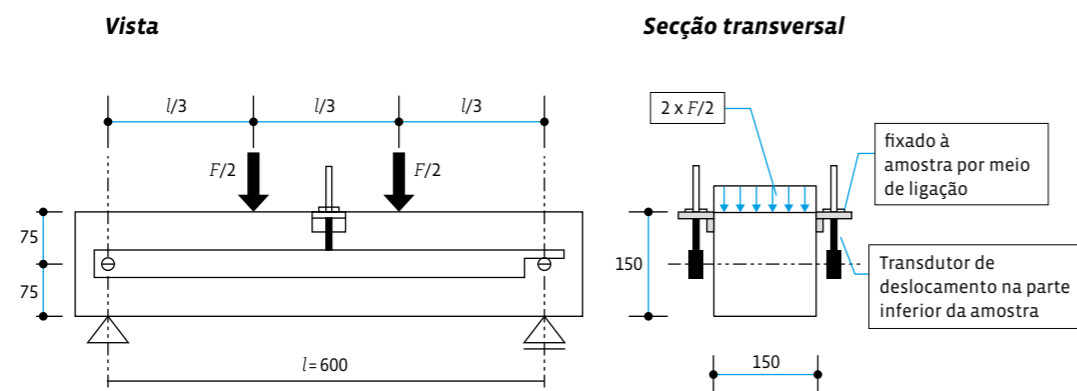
Dispositivo de medição para determinar as resistências à tração pós-fissuração (dimensões em mm) para o ensaio de flexão em 4 pontos [2].
